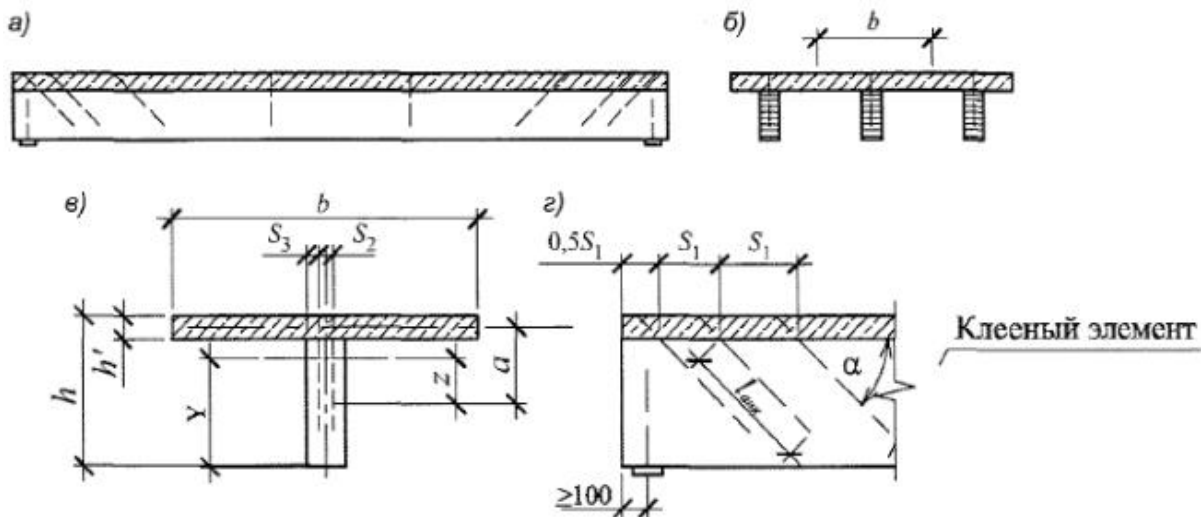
Балка композитного сечения: а) - общий вид; б) - поперечное сечение; в) - геометрические характеристики поперечного сечения; г) - опорная зона балки
